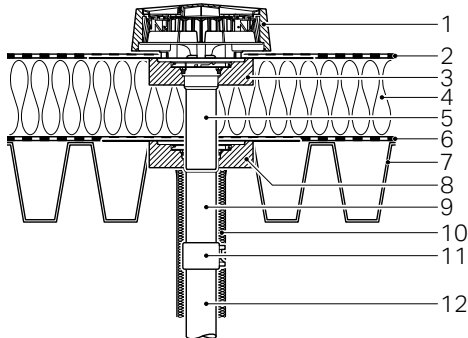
Aufbau Leichtdach gedämmt, mit Bitumen-Dachabdichtung und Dampfsperrenanschluss
